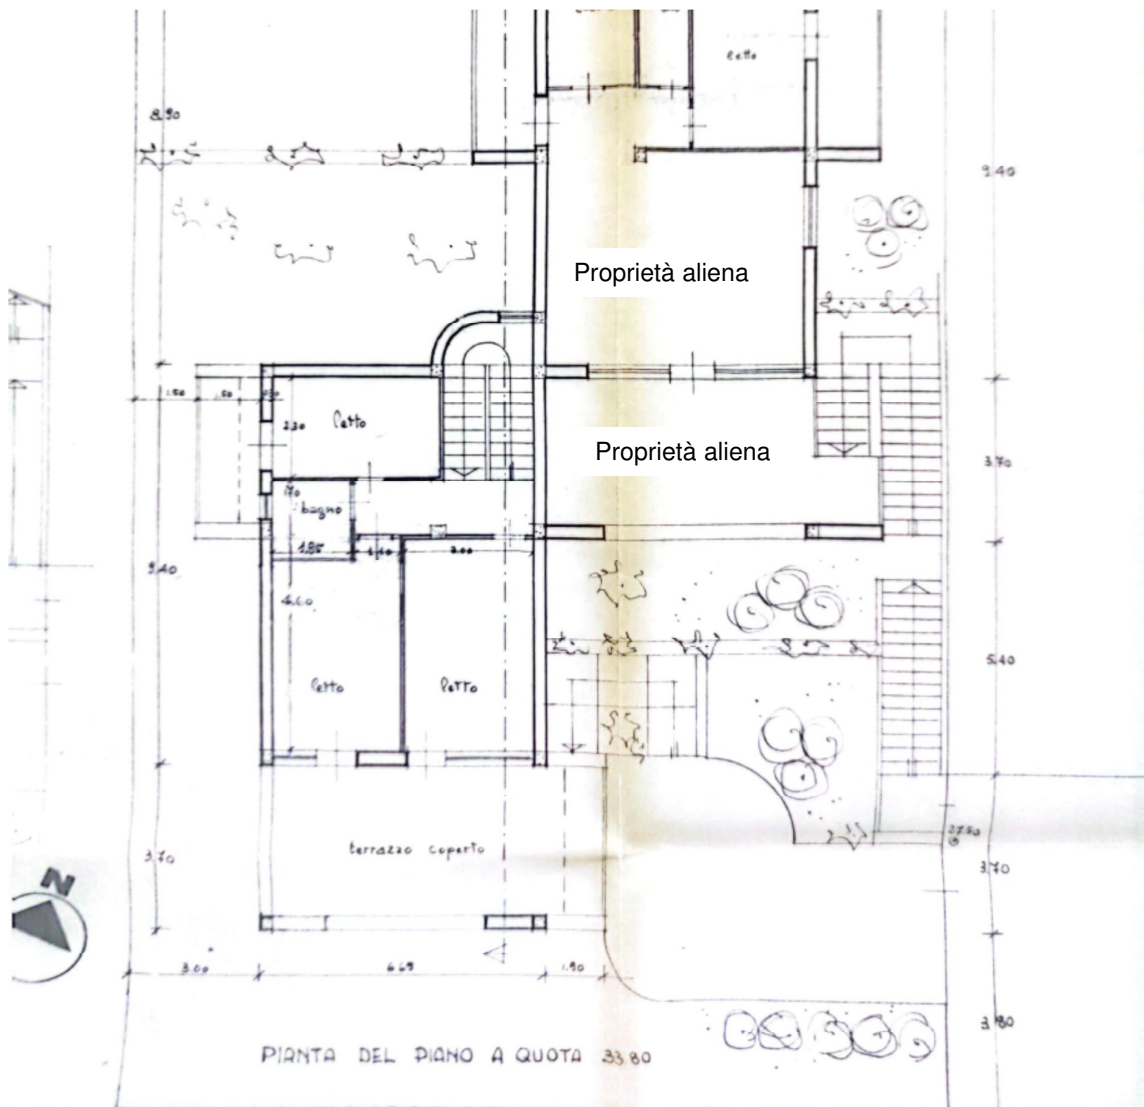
stralcio elaborato di progetto allegato al progetto in variante alla Licenza edilizia n. 615 del 22/036/1978
